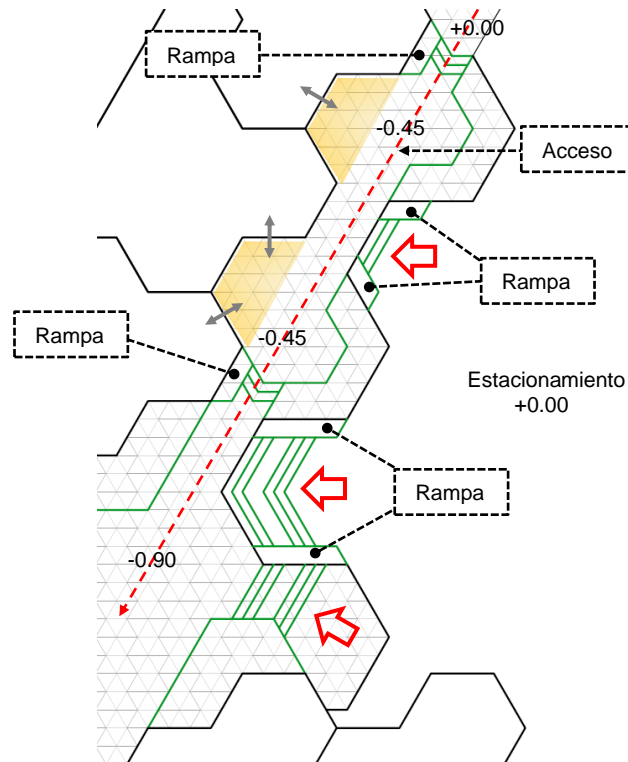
Sector 1, Desarrollo de Rampas y Escaleras
